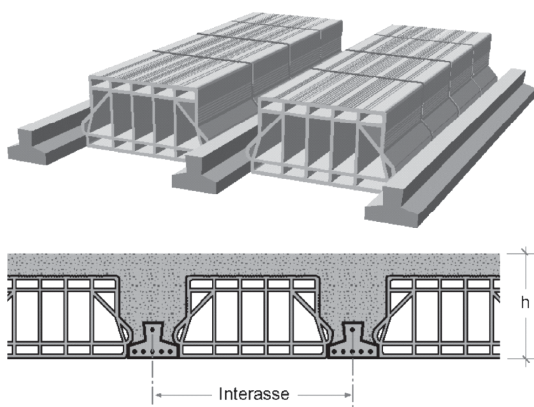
Esempio di solaio a travetti prefabbricati in calcestruzzo armato e blocchi di laterizio interposti³
